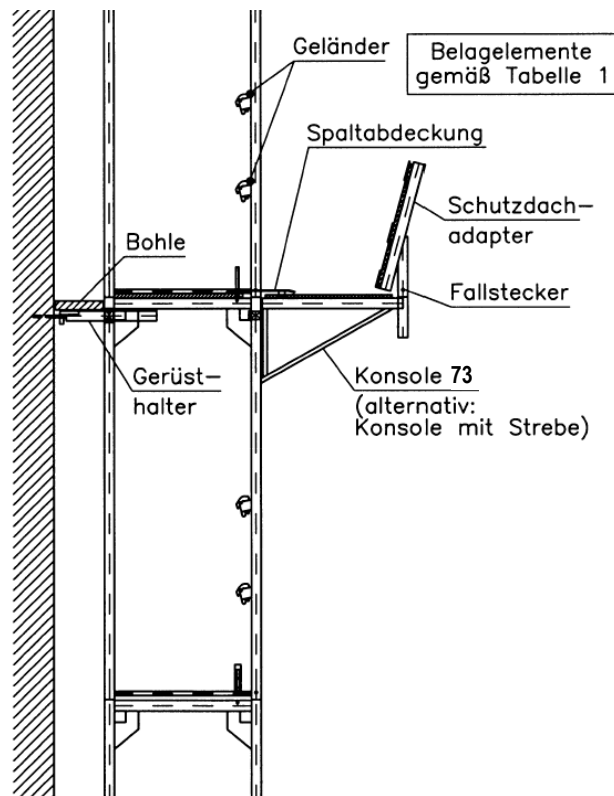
Schutzdach mit Schutzdachkonsolen
